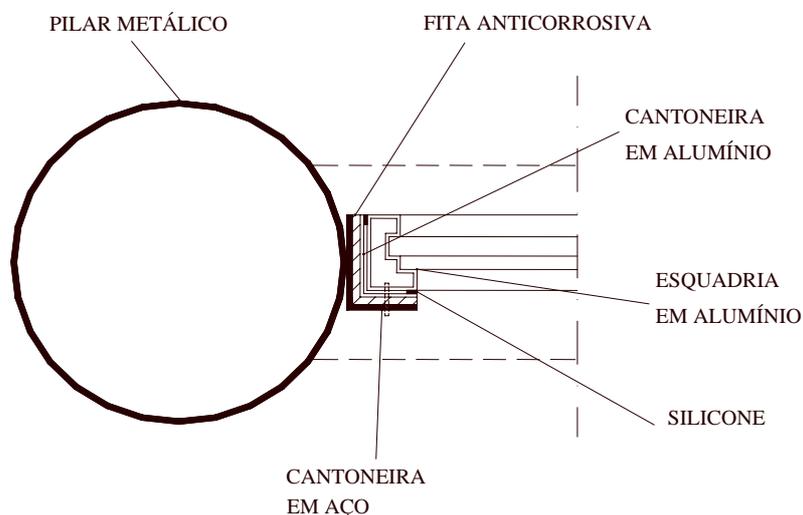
Seção 1-1 da Figura 7.2: a interface do painel com o pilar metálico, em planta.
